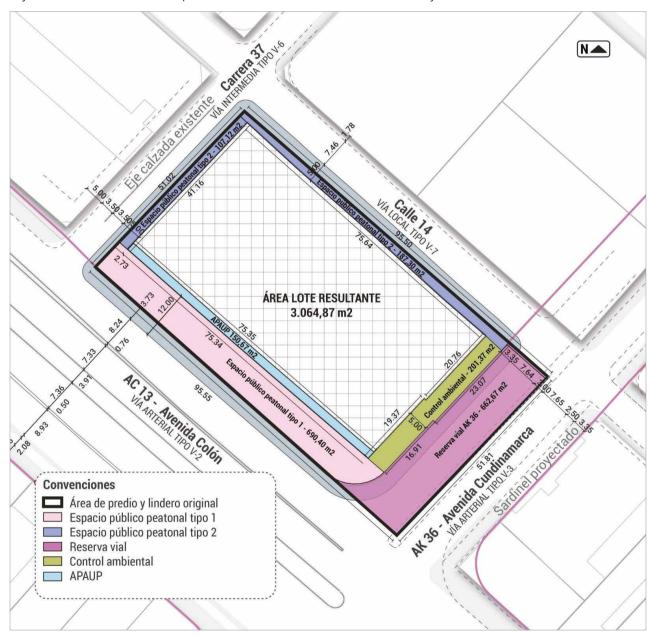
Planteamiento urbanístico Fuente: Elaboración propia
